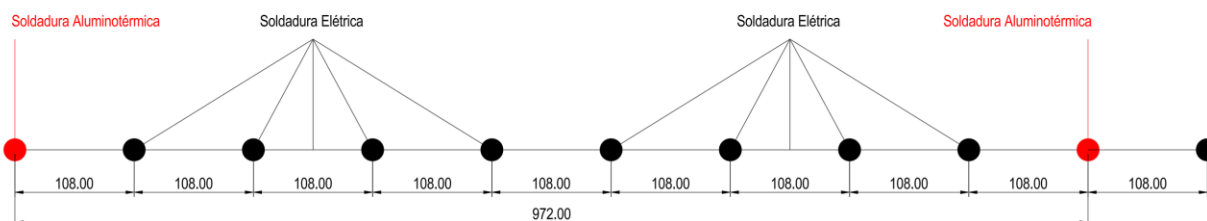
Esquema de tipo de soldadura a aplicar
